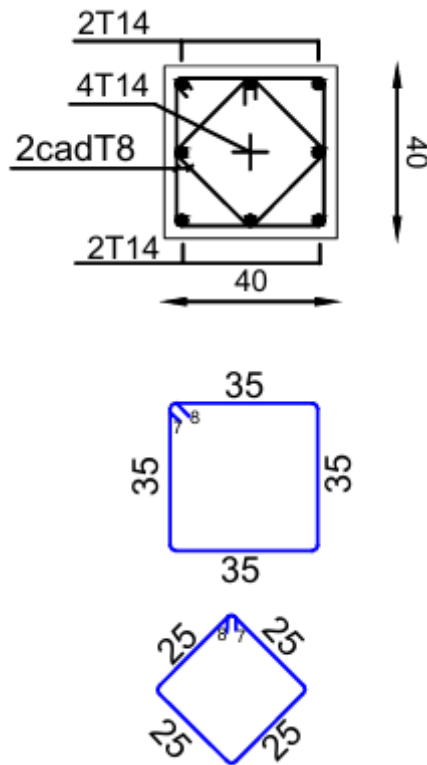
Schéma de ferrailage de poteau (40*40).
